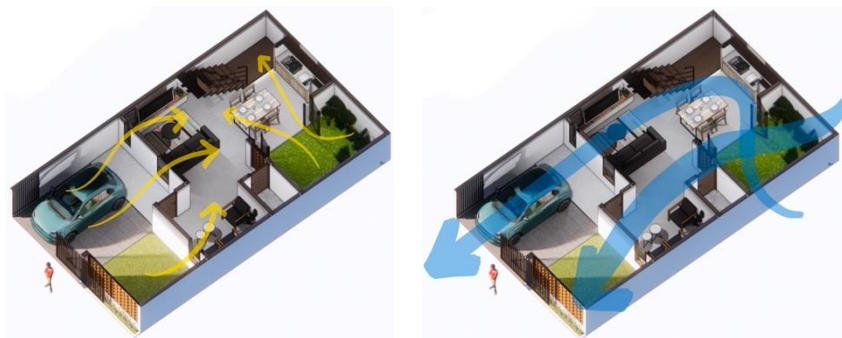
Perbandingan Denah Eksisting dan Rencana Denah Pengembangan
